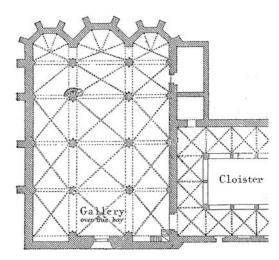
Burgos. Iglesia del San Esteban, planta general (Street [1865] 1926)
